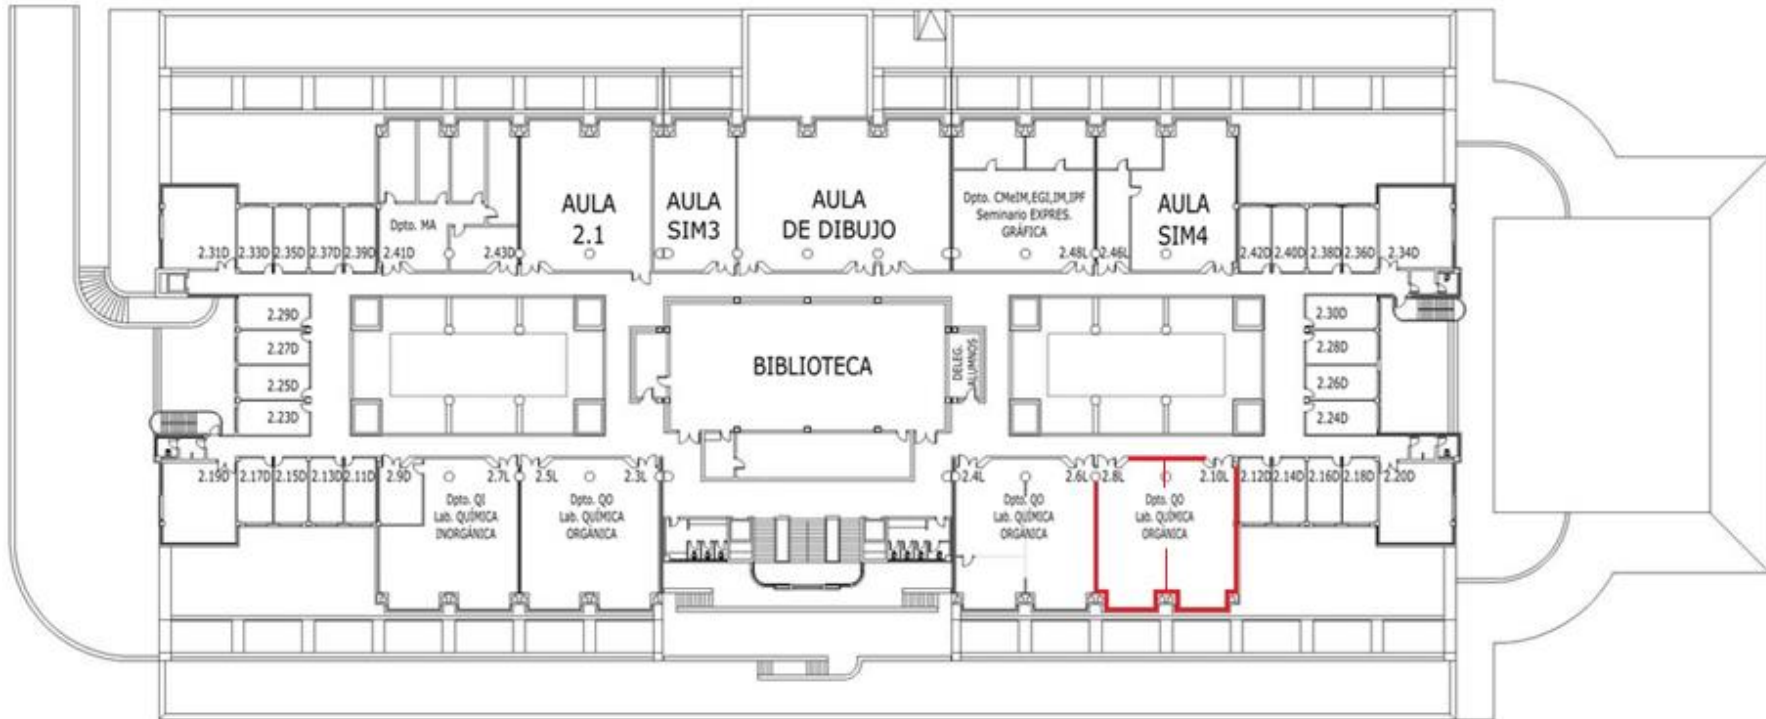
Plano de la segunda planta de la Sede Paseo del Cauce donde se ubica el objeto de estudio.
